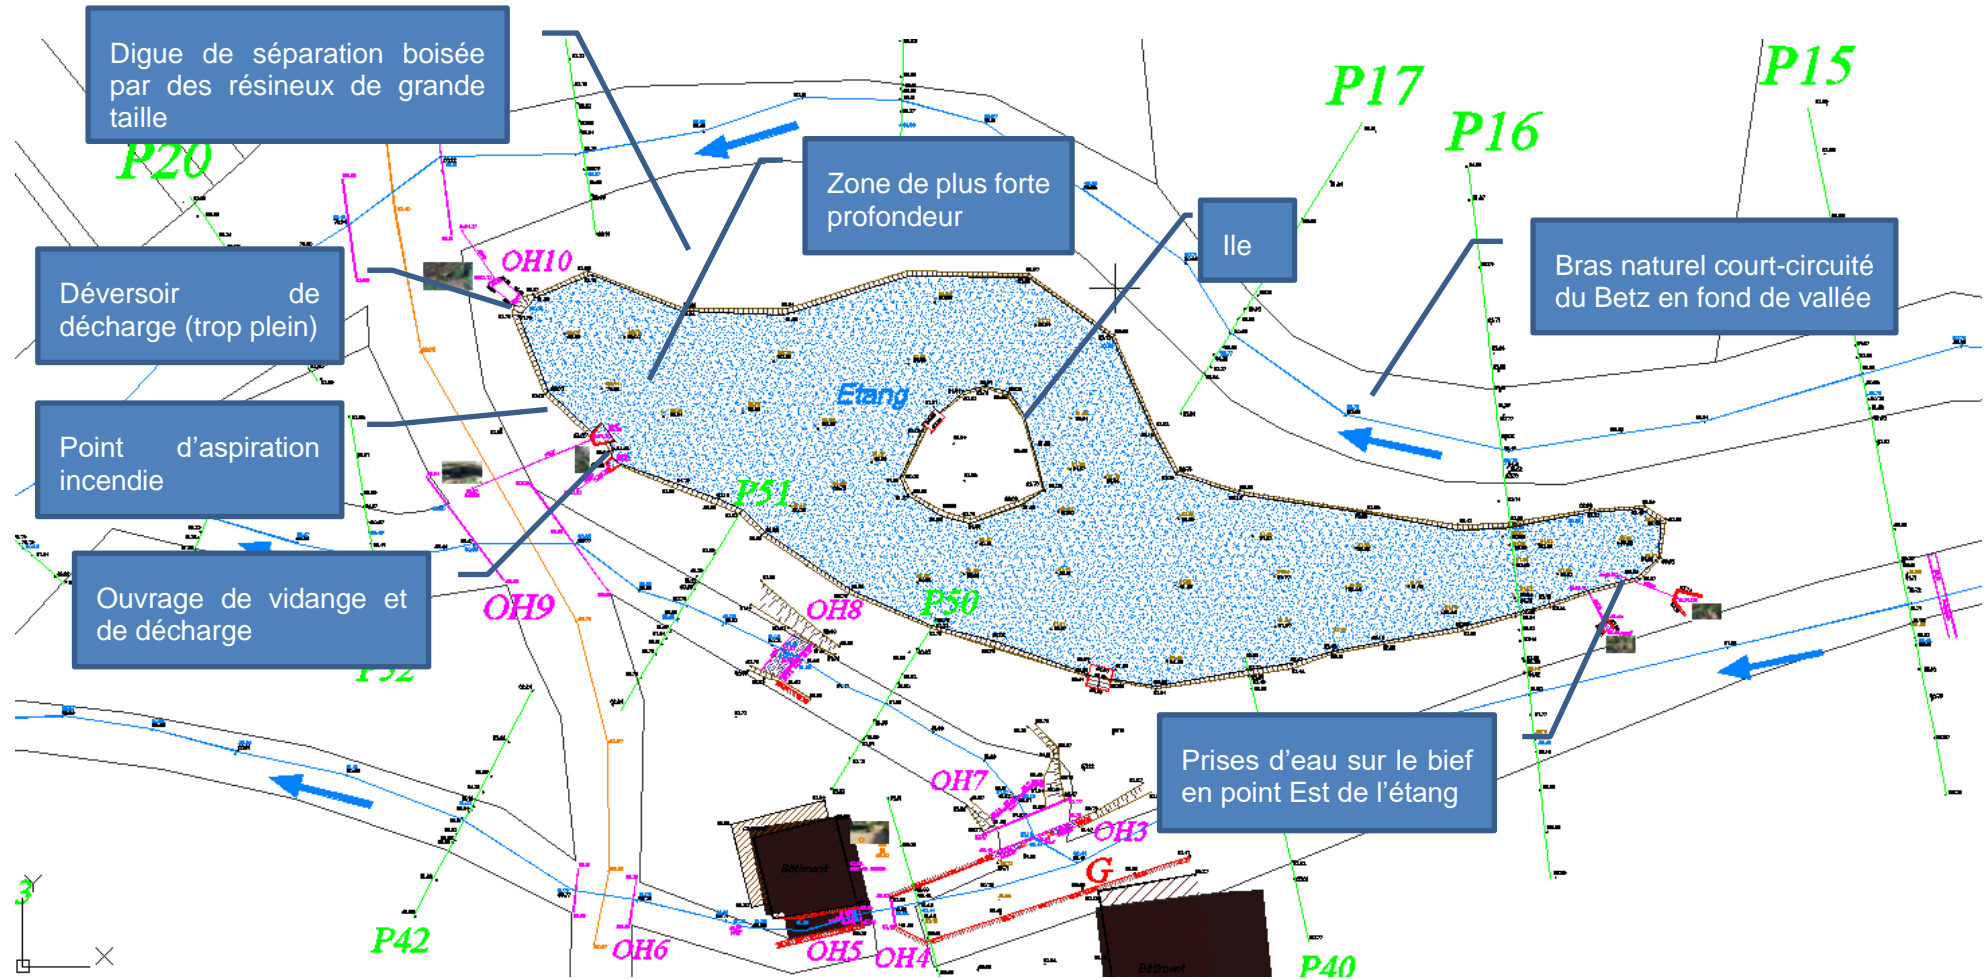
Vue en plan au droit du plan d'eau en rive droite du bief du moulin Brandard
